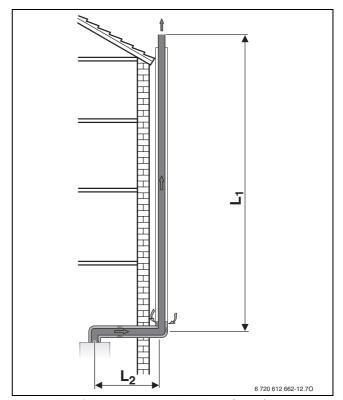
Abgasführung an der Fassade nach C_{53} (GAF-K)
